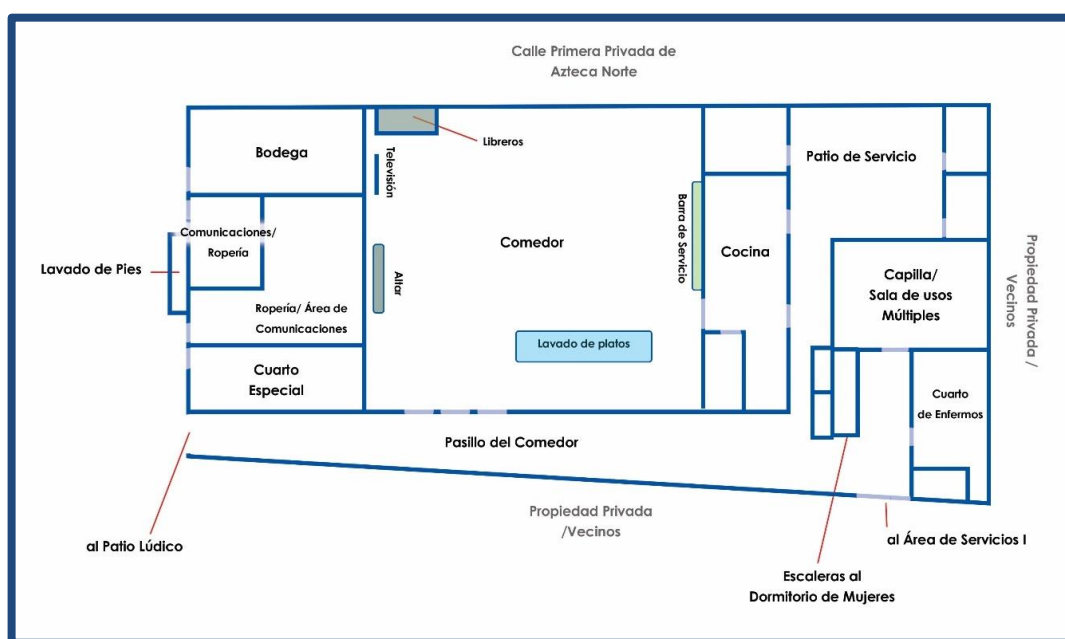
Área de Servicios II Planta Baja (ASIIB).
